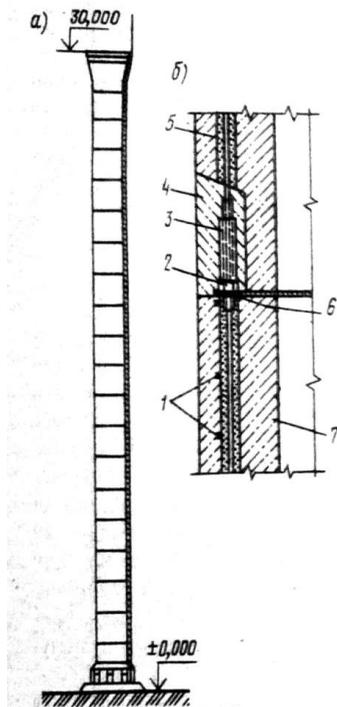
Сборная предварительно напряженная цилиндрическая дымовая труба из жаростойких железобетонных царг:
